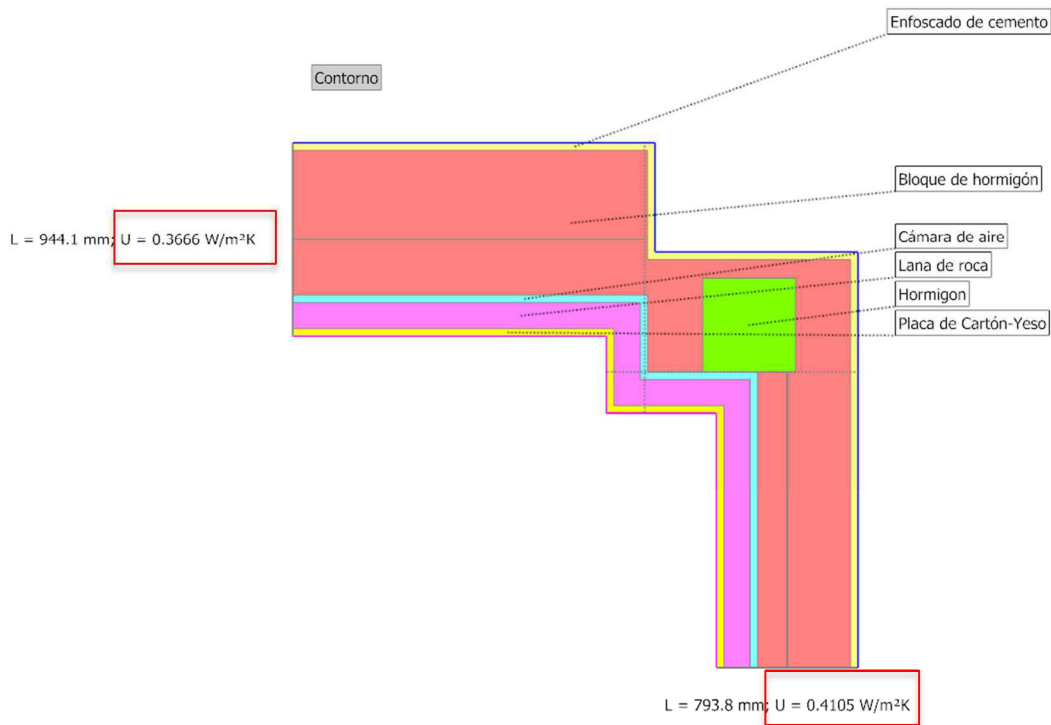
Detalle del puente térmico de pilar en esquina con indicación del cálculo obtenido con TERMUS-BRIDGE. Elaboración propia.
